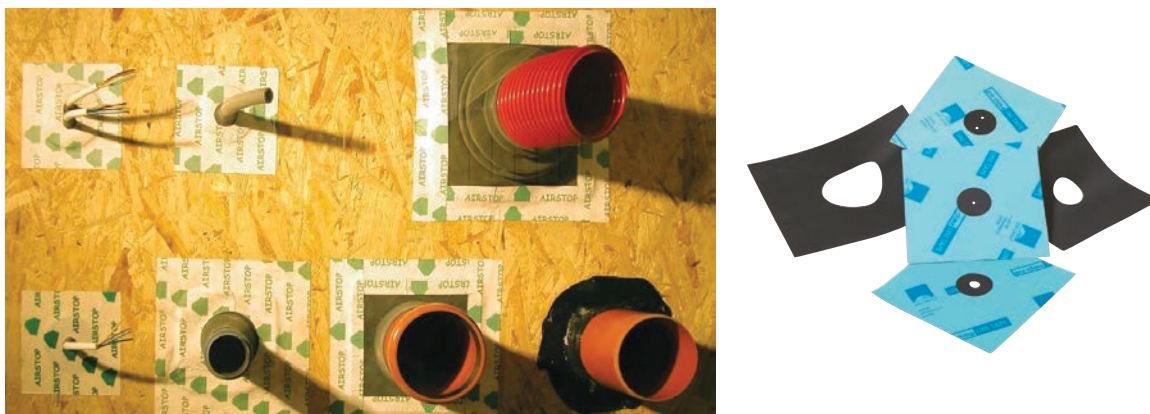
Brtvljenje proboja kroz konstrukciju instalacijom mekane pregrade [170]
